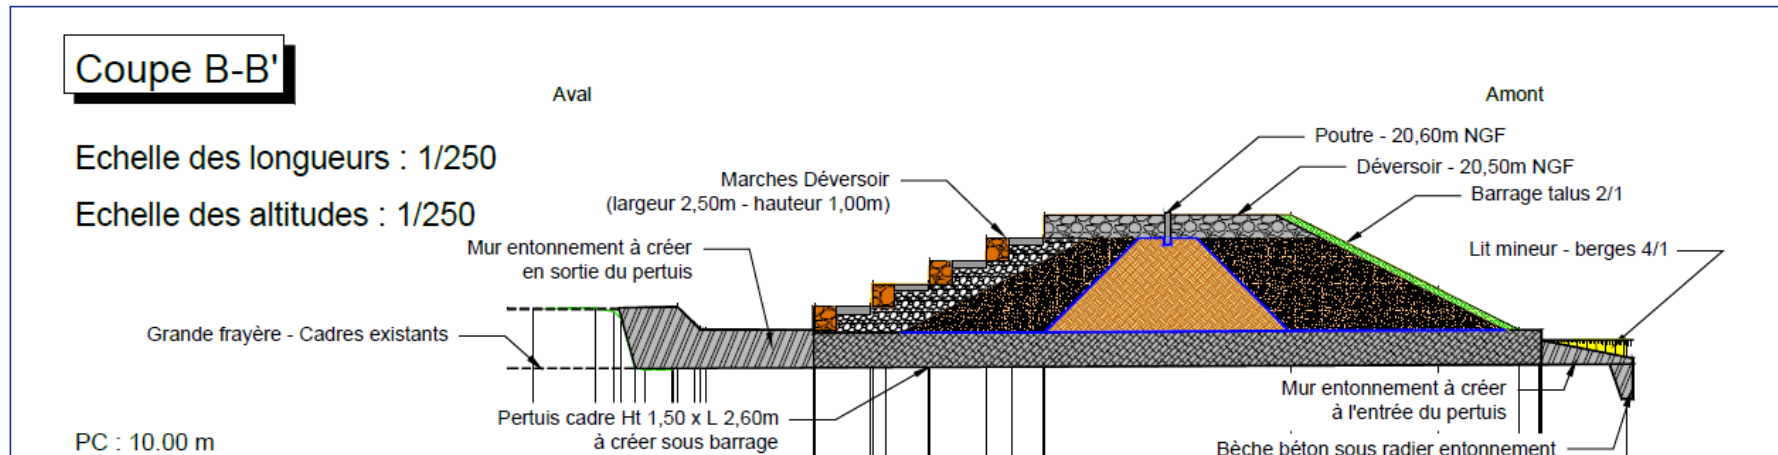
Profil en long à travers l'évacuateur de crues – Plan AVP
